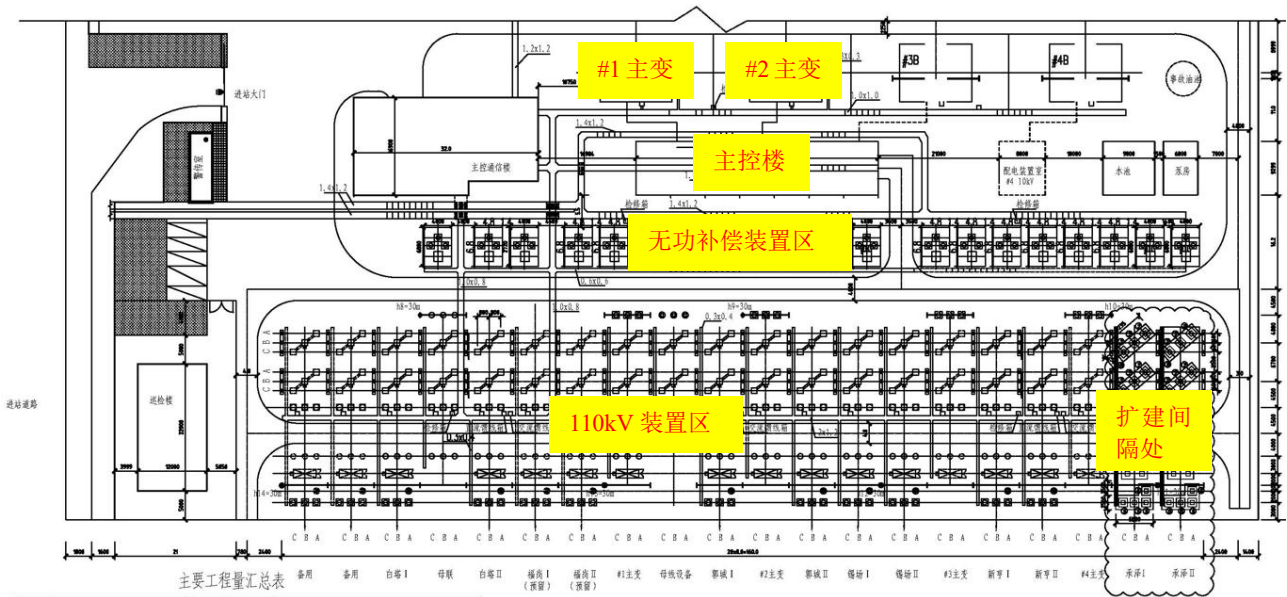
220kV 锦霖站总平面布置示意图（扩建后）
